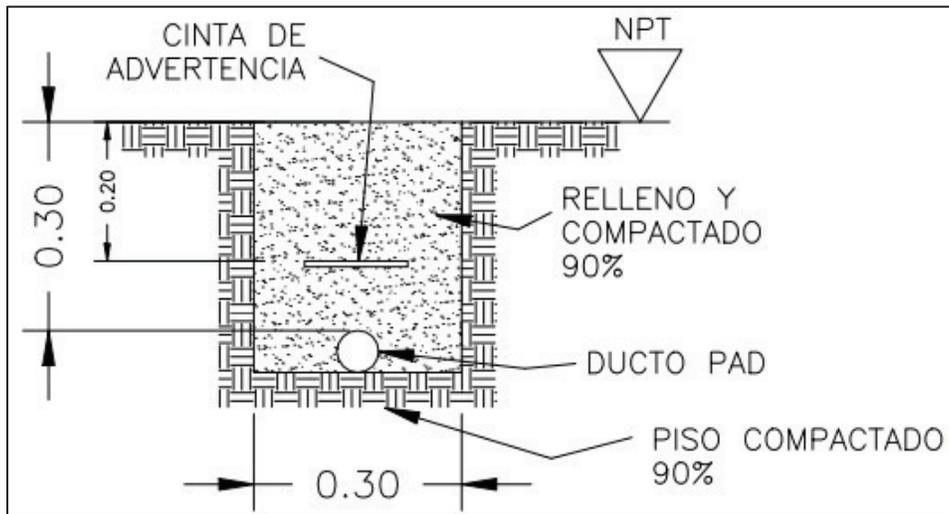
Detalle Ceba en Baqueta con Ducto de PAD.
